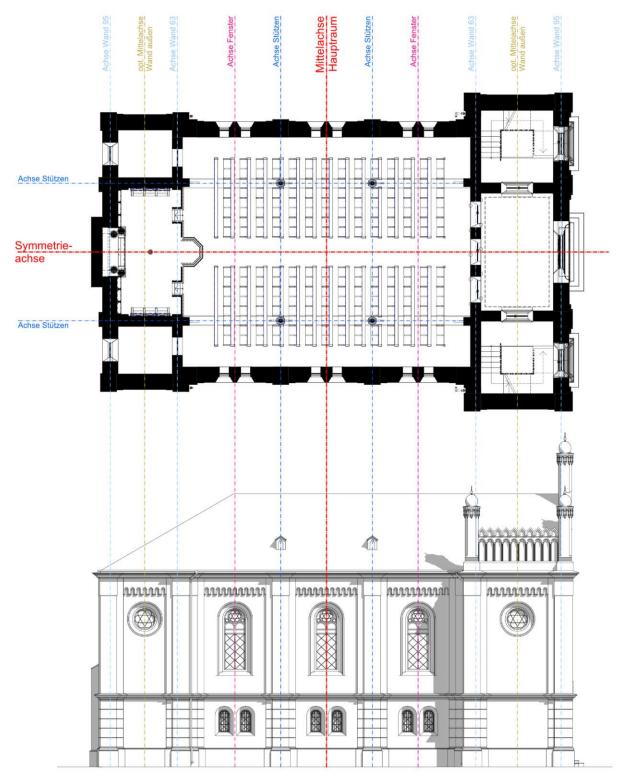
Achsraster in Grundriss Erdgeschoss und Ansicht Nord
